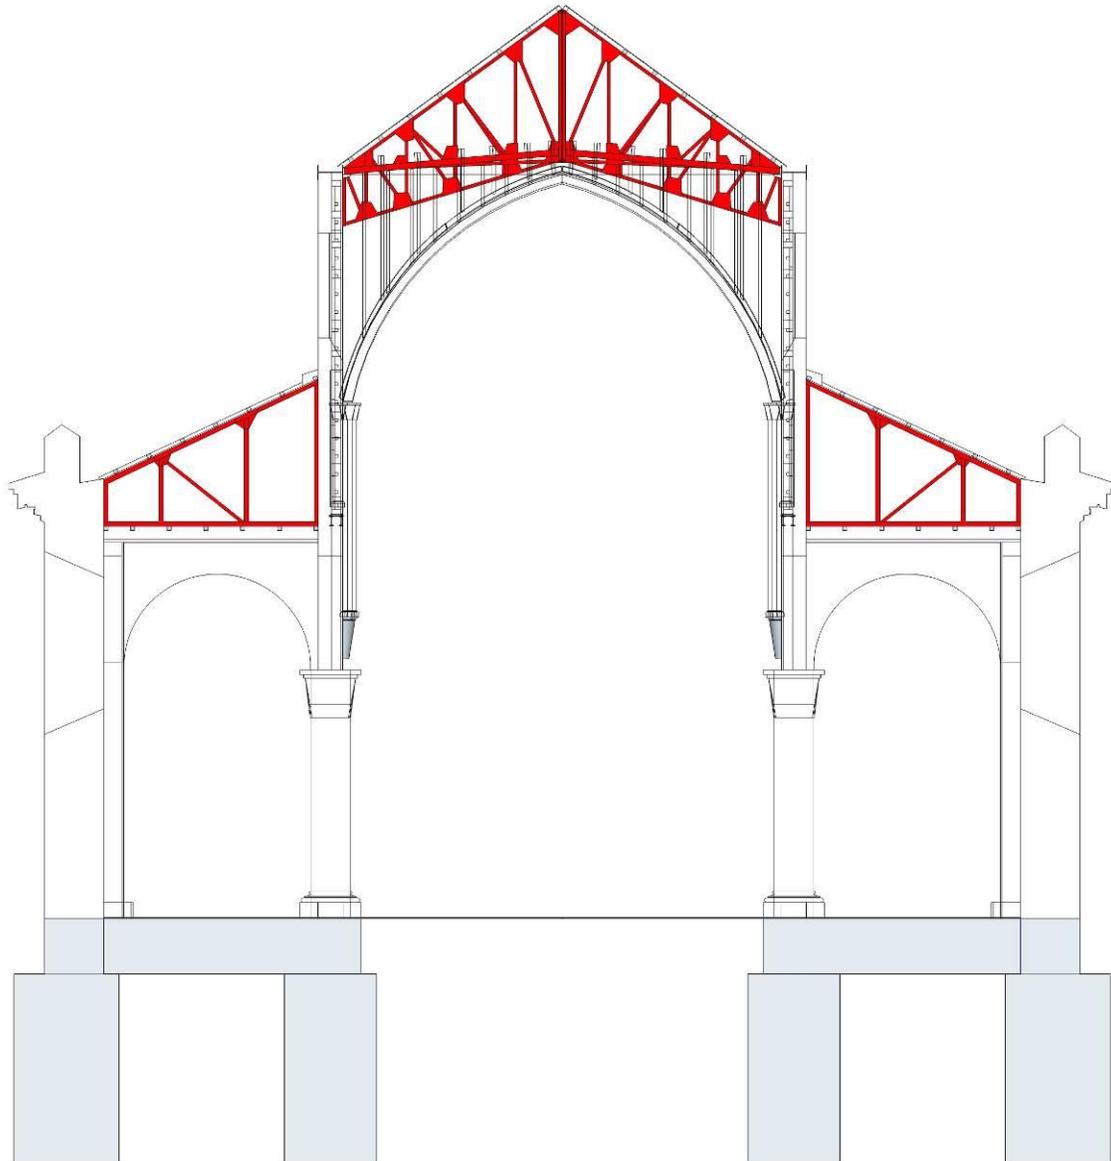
Corte transversal de estructuras de nave y en rojo indica estructuras metálicas. Elab, propia
